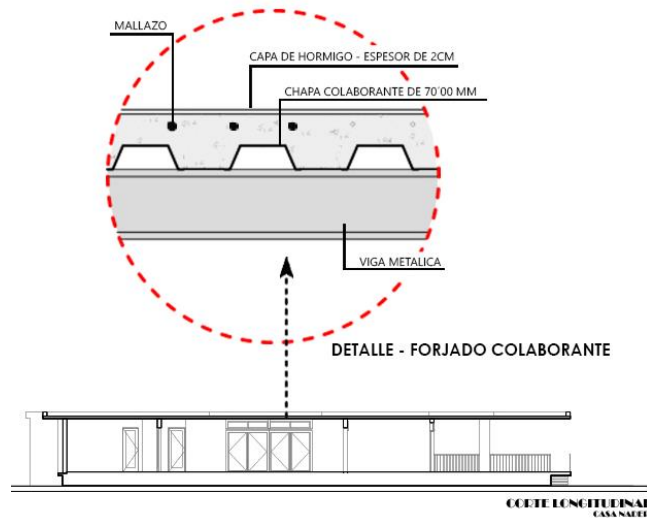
Sistema constructivo losa aligerada en modelo 2 Nader. Fuente: Elaboración Propia
